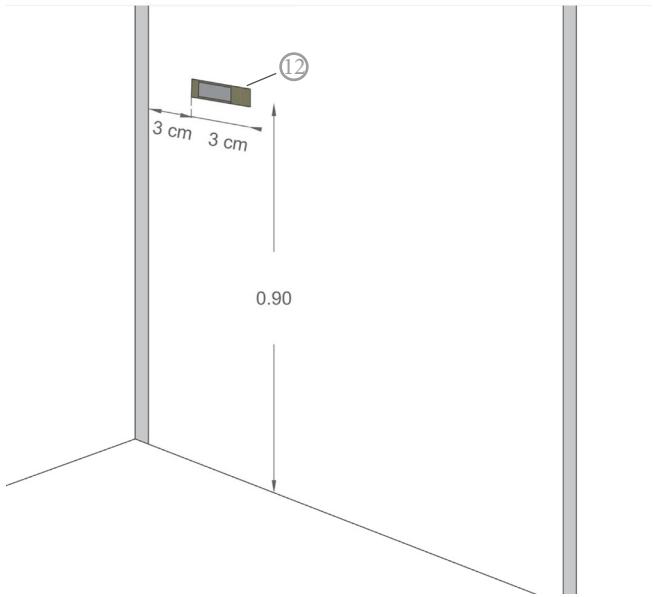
2 Cerraduras en puertas y ventanas
